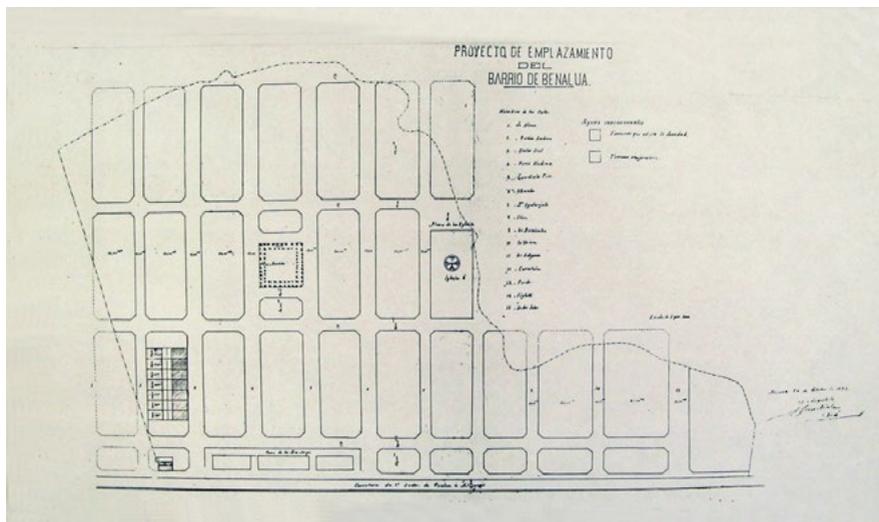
Plano de planta general del proyecto de Benalúa (arquitecto Guardiola Picó, 1883). Fuente: Archivo Histórico Municipal de Alicante.
